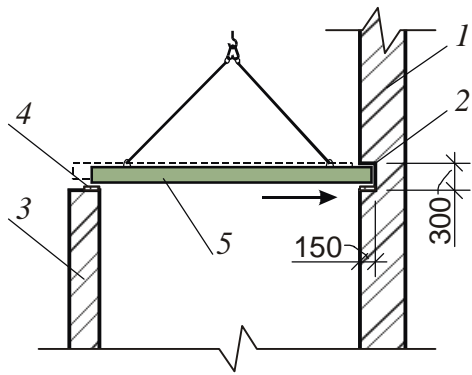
Монтаж панели перекрытия при возведении внутренней стены:
